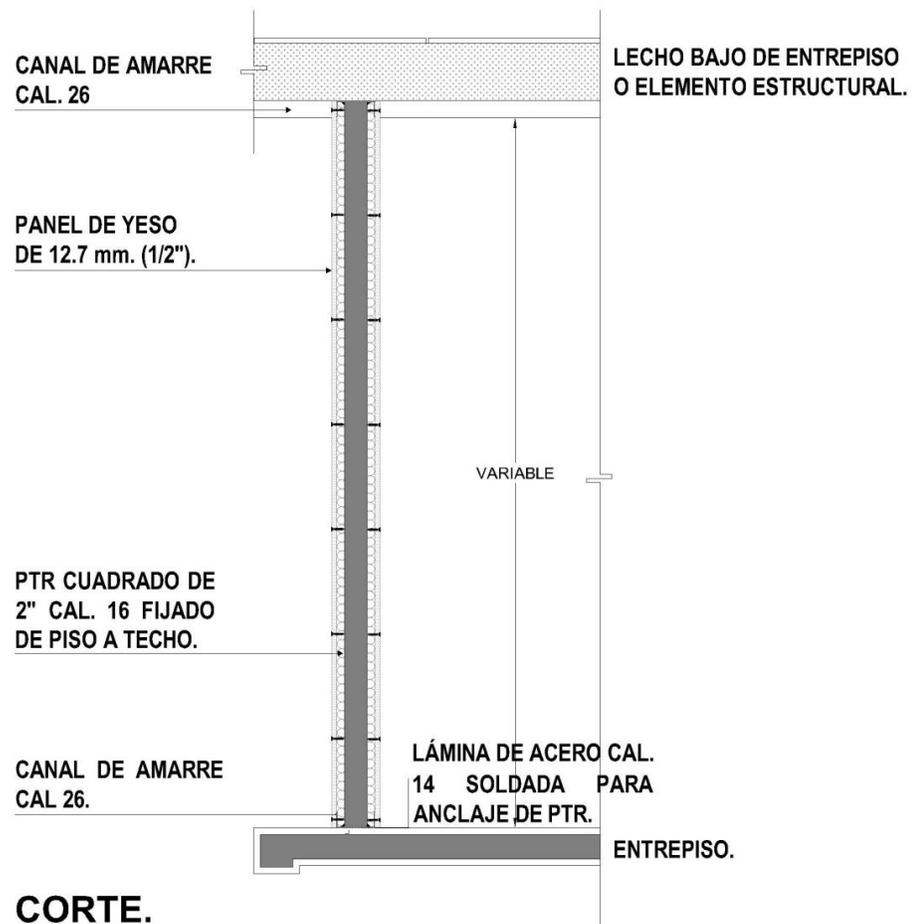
Ejemplo 1 de refuerzo en muros de tablaroca para soporte de pantalla.
